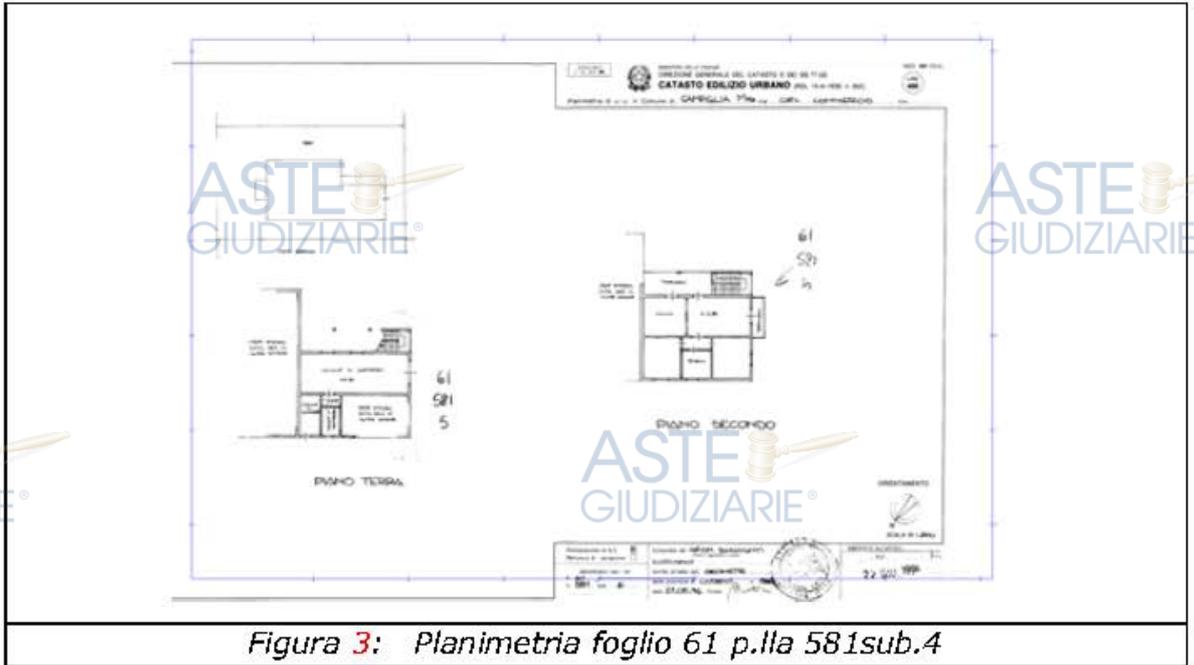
Planimetria foglio 61 p.lla 581sub.4
